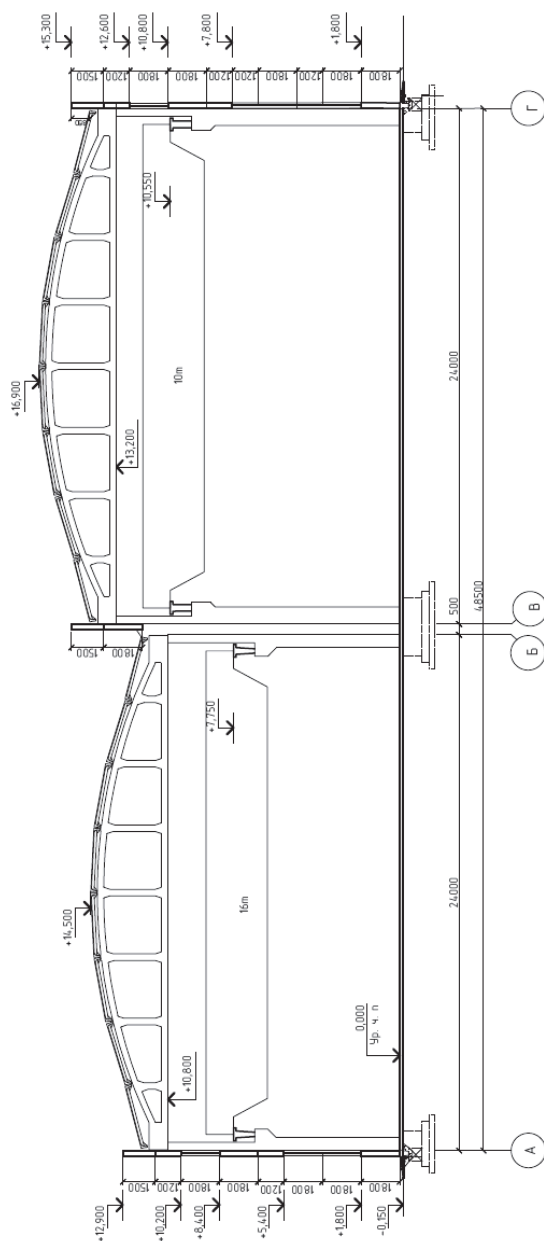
Схема монтажных горизонтов железобетонных элементов каркаса в пролетах здания разной высоты до низа стропильных конструкций (выполнено Н.С. Рачевой, гр. ПГС-09-1)
